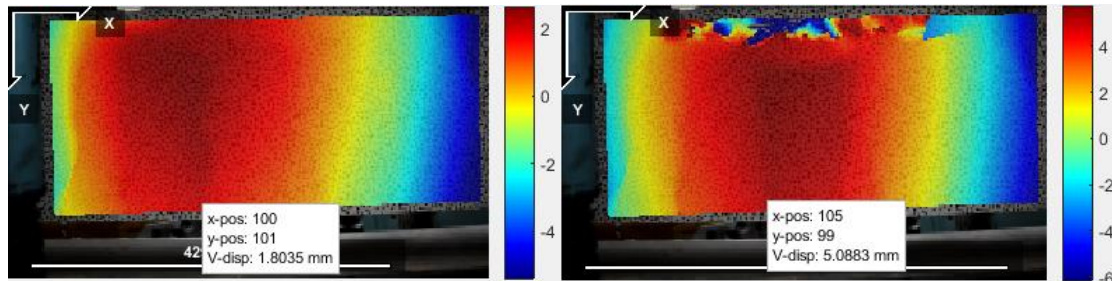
Deflexiones en el centro de la luz en una viga de concreto reforzado en el instante de máxima resistencia y al momento en que se presenta la falla por flexión.
